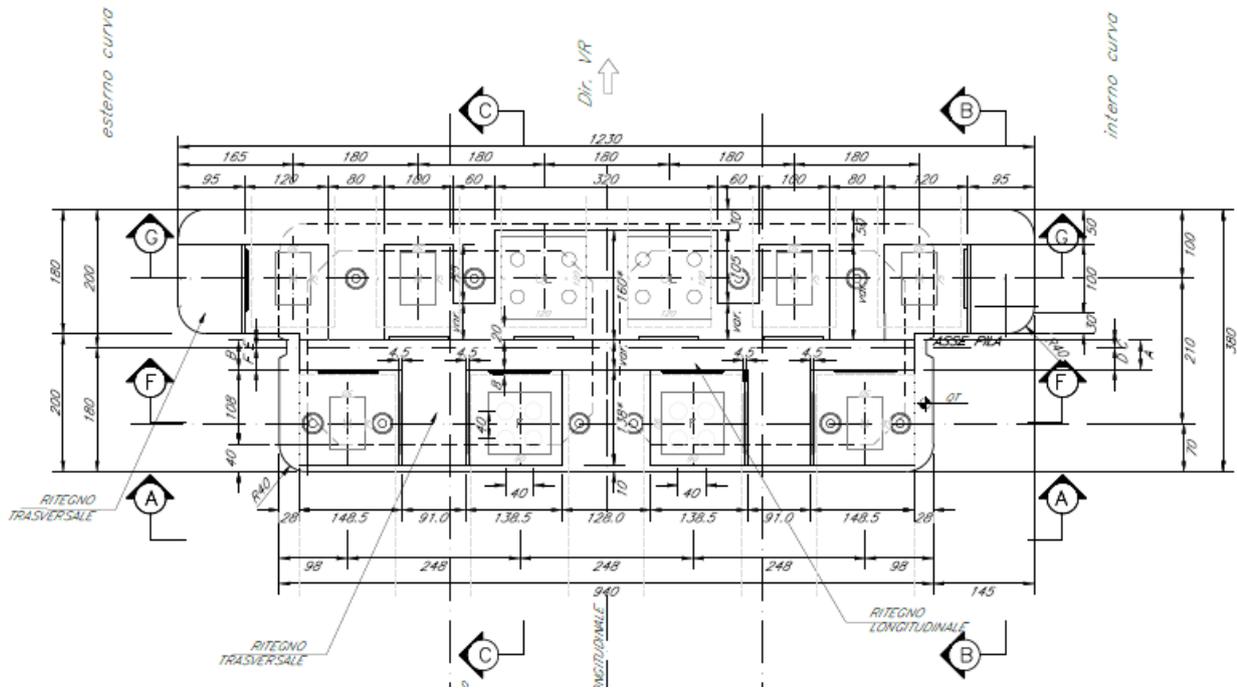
Sezioni e pianta pulvino (Allineamento fisso lato impalcato in Misto)
